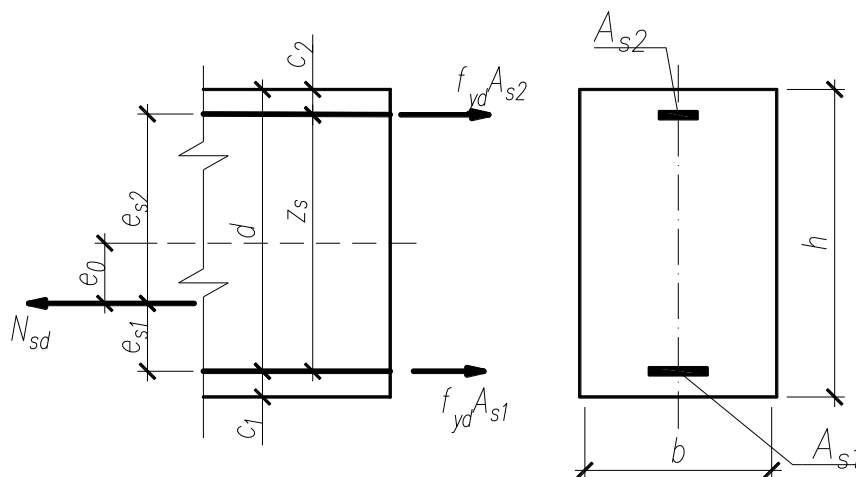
Схема усилий и эпюра напряжений в сечении, нормальном к продольной оси внецентренно растянутого железобетонного элемента, при расчете по прочности (случай малого эксцентриситета)
